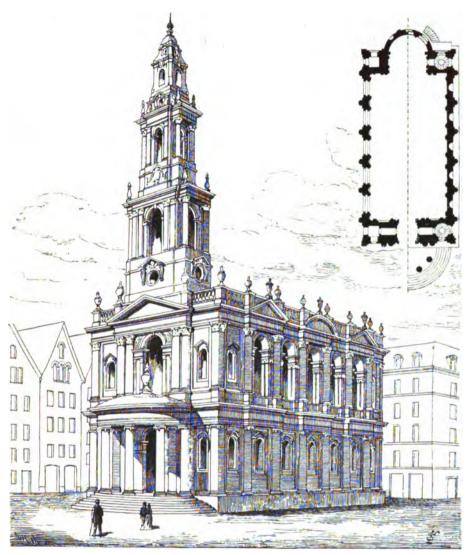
St. Mary le Strand zu London. Ansicht und Grundriss.
